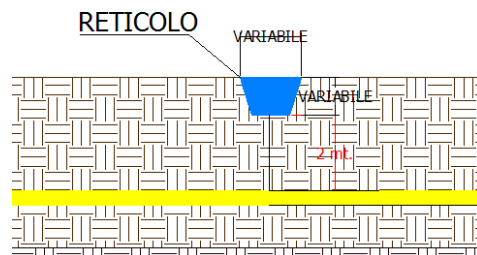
Posizione del cavidotto rispetto all'alveo.
